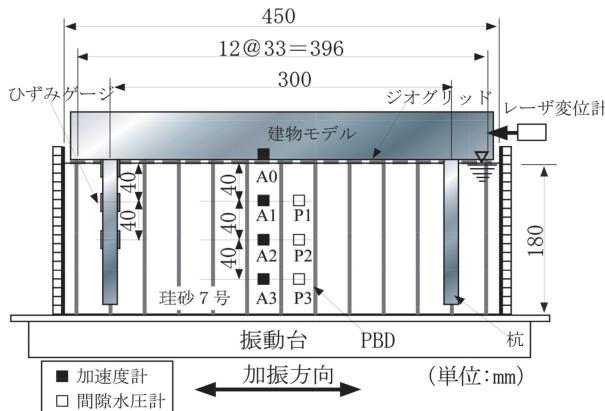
模型地盤の断面図 (摩擦杭・対策あり (Case5))
